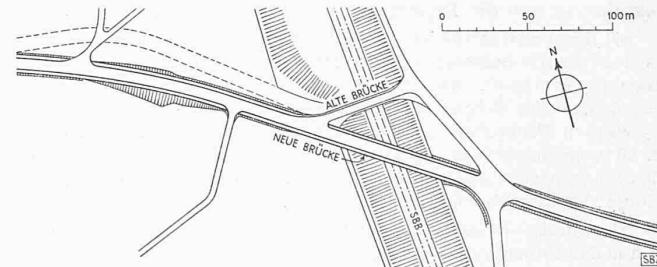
Lageplan der Strassenkorrektion. — 1:4000
